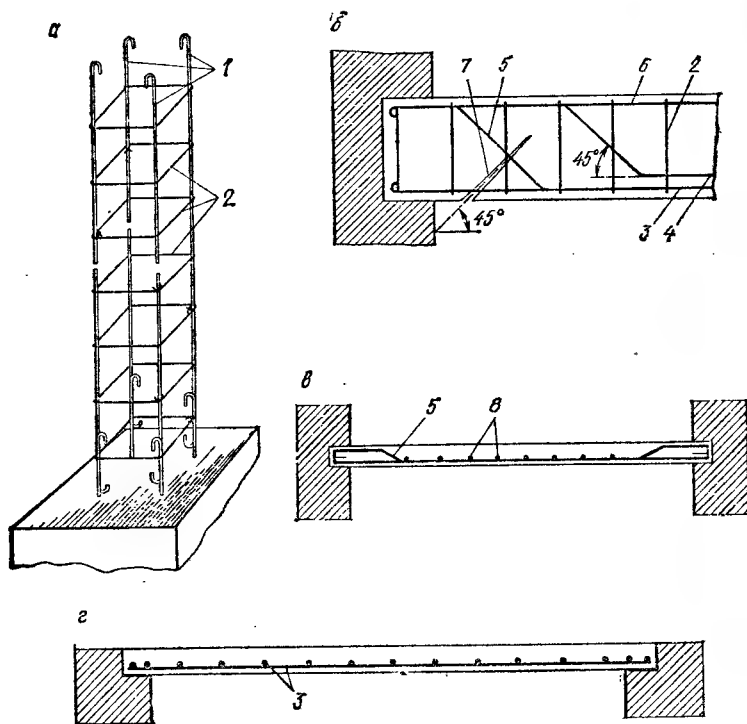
Арматура основных элементов железобетонных конструкций
